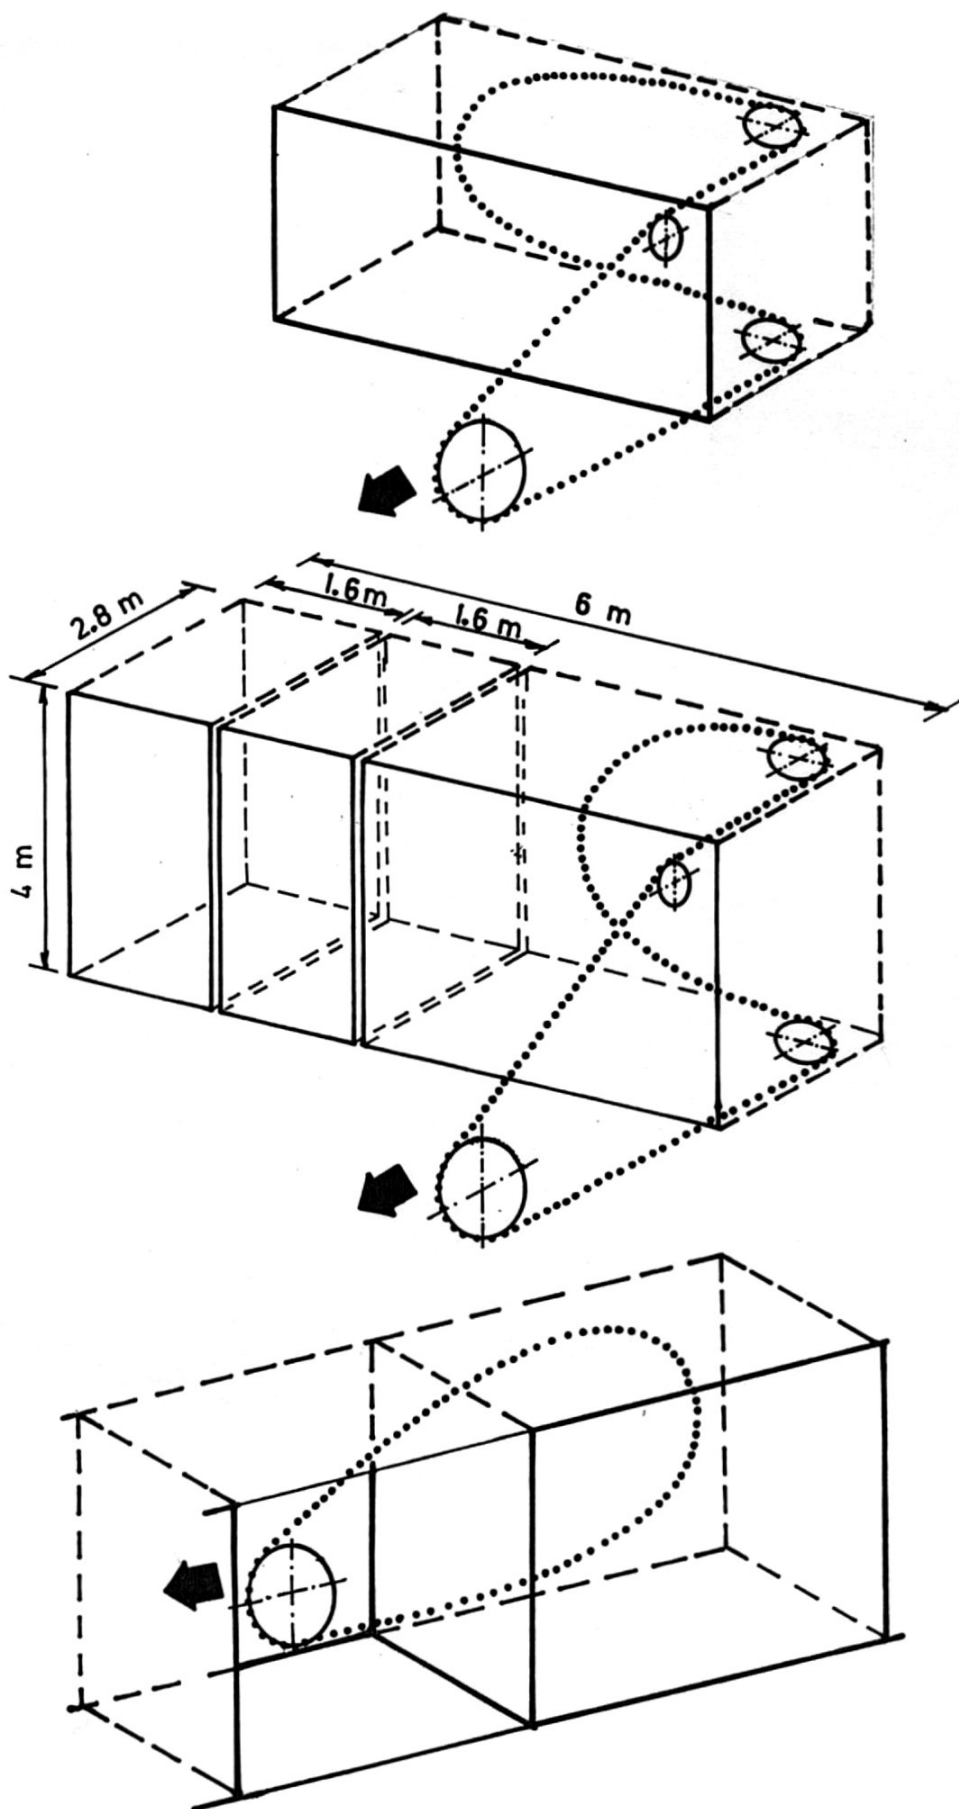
Shema otvaranja podzemnog kamenoloma - piljenje stražnjeg reza dijamantnom žičnom pilom
